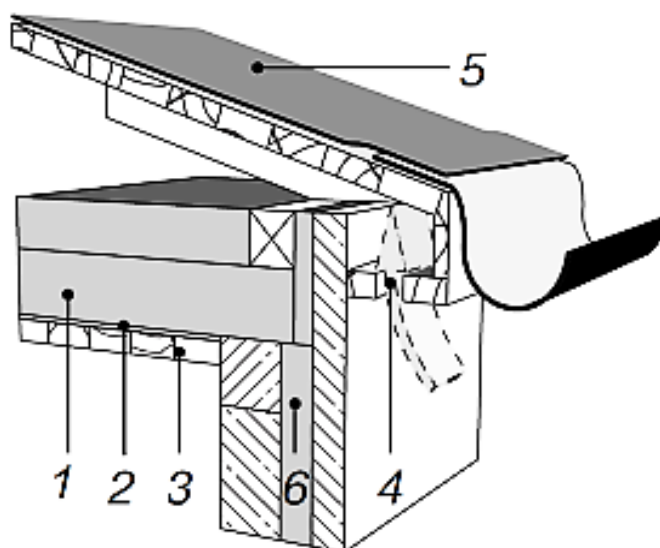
Узел системы теплоизоляции: 1 – ТЕРМО МАТ; 2 – Пароизоляция; 3 – Конструкция подшивки потолка; 4 – Вентиляционное устройство; 5 – Кровля; 6 – ТЕРМО СЛОЙ (теплоизоляционный)
